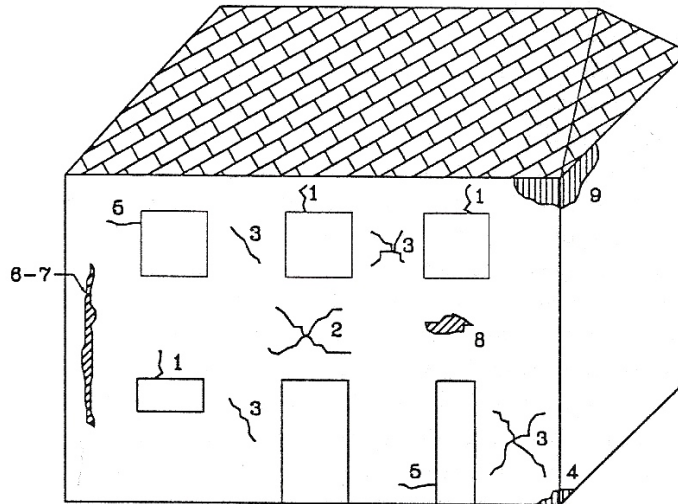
Tipo de agrietamientos considerados en muros verticales de mampostería.
